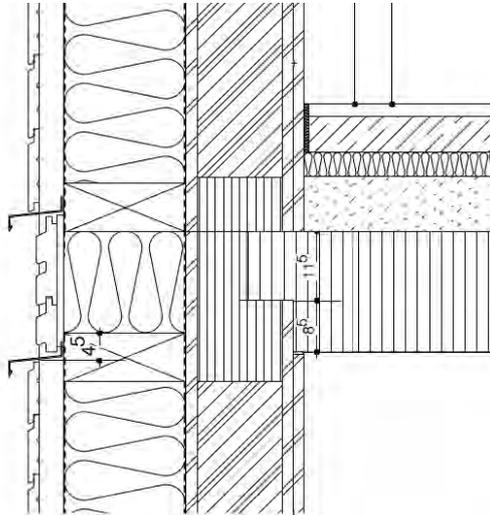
Auf der Baustelle montierte Deckenstirn-Bekleidung
